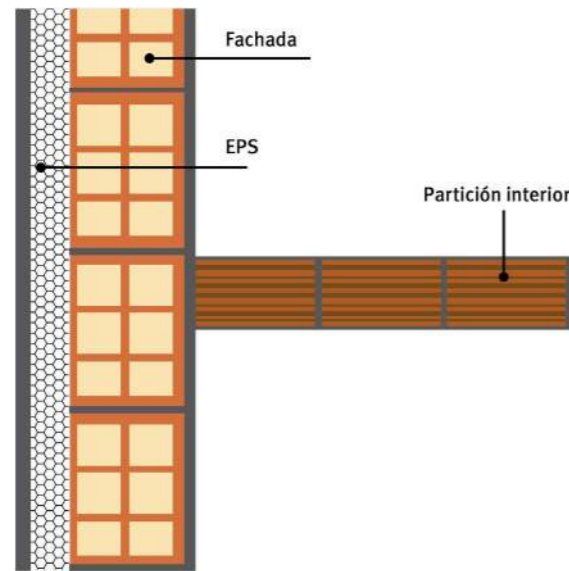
Detalle 4. Sistema SATE. Encuentro de fachada con particiones interiores.
